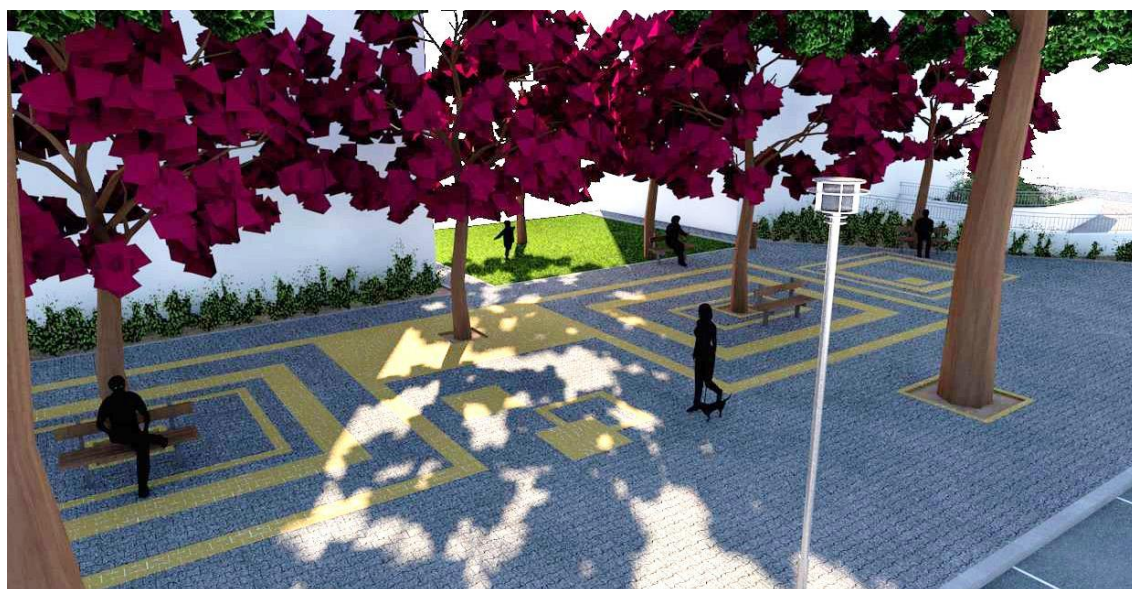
Perspetiva (8) do desenho de pavimento (Fonte: autora do trabalho)
